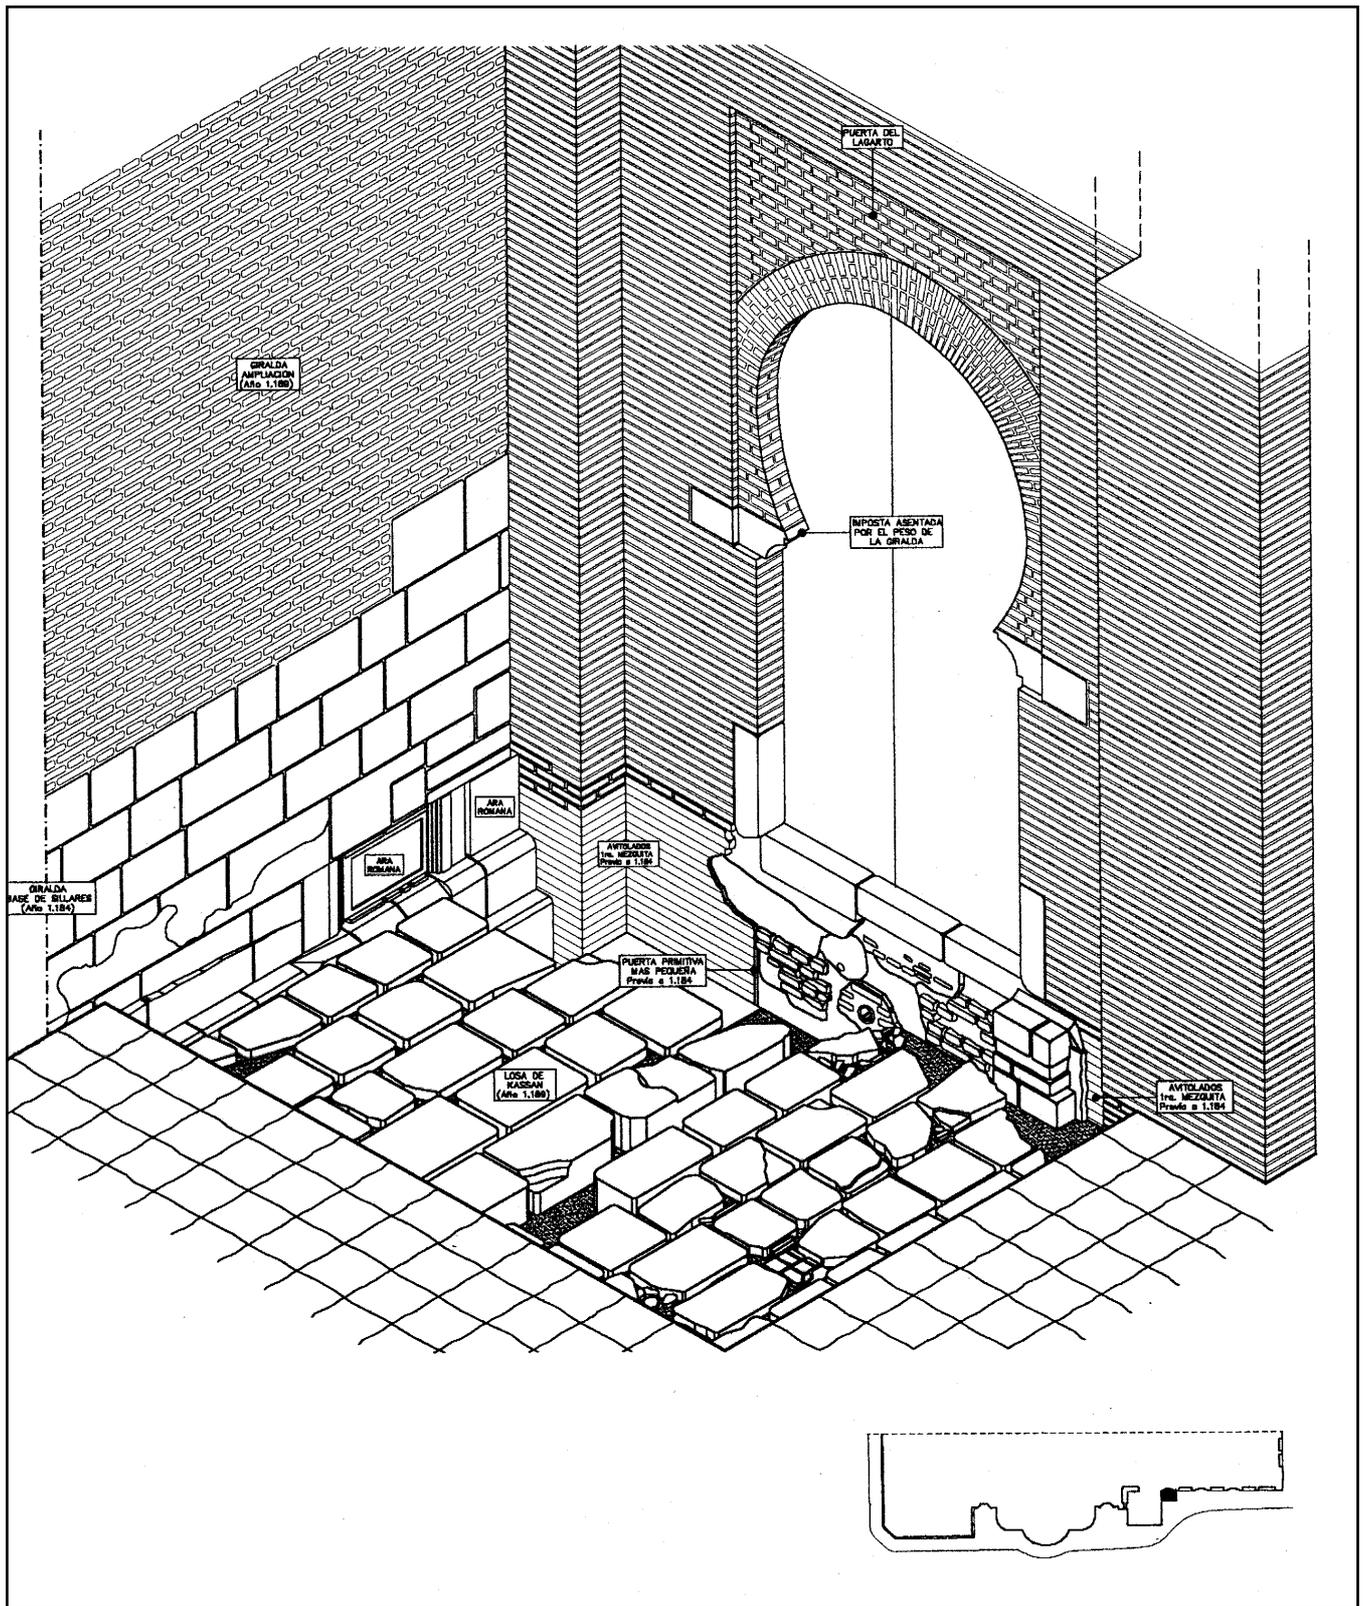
Estratigrafía de la Puerta del Lagarto. Obsérvese la pavimentación almohade a base de sillares de roca alcoriza (losa de Kazán, según Al Salá)
